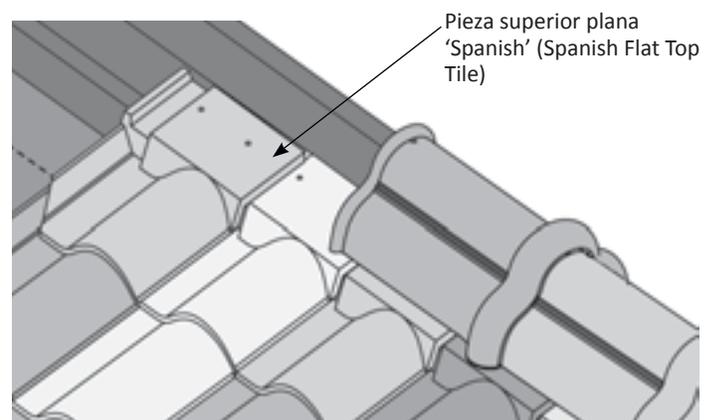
Detalle de pieza superior plana 'Spanish' (Spanish Flat Top Fixture)
